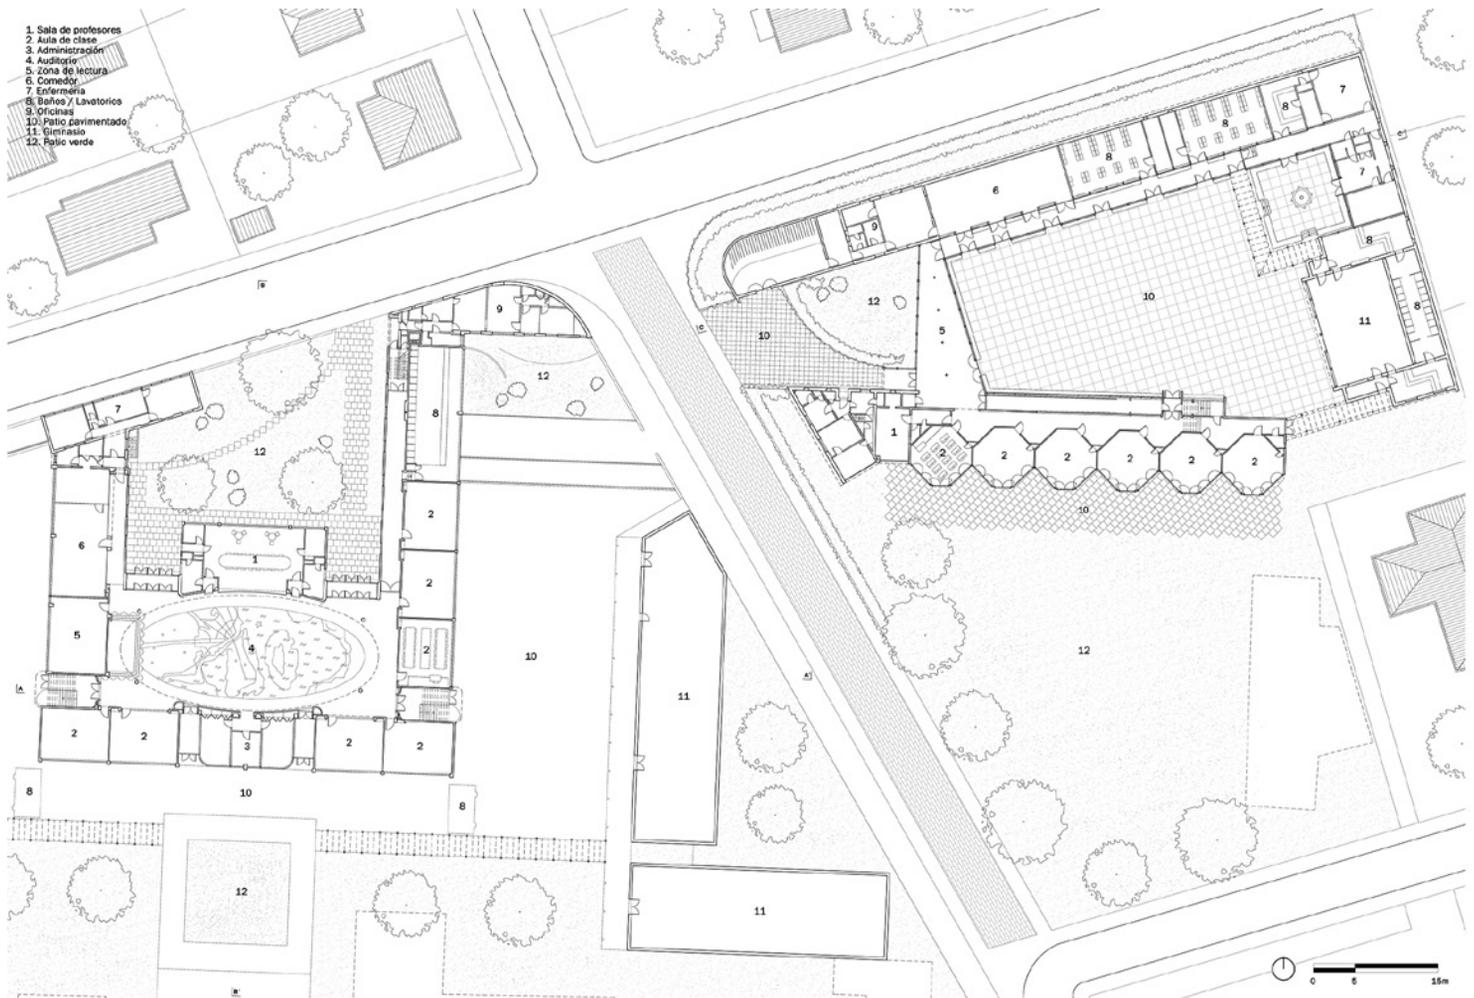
Planta del conjunto escolar, primer nivel a escala 1:200. Fuente: elaboración propia en base a la planimetría original del proyecto por Kaj Gottlob del año 1937 y 1938.
